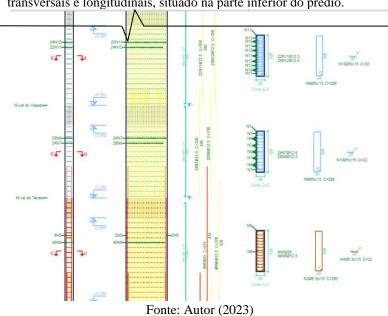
Pilar 04 com maior dimensão, maior carregamento e maior quantidade de armaduras transversais e longitudinais, situado na parte inferior do prédio.
